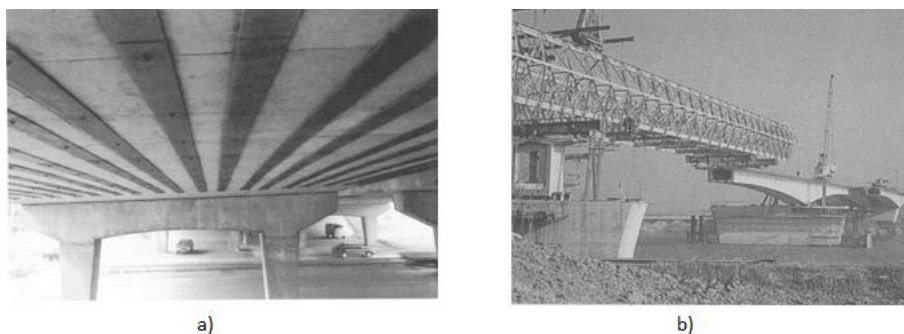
a) Reforço da estrutura de uma ponte com placas de aço [17]; b) Construção de uma ponte por segmentos, tirando-se vantagem do endurecimento à temperatura ambiente dos adesivos de epóxico [24]
